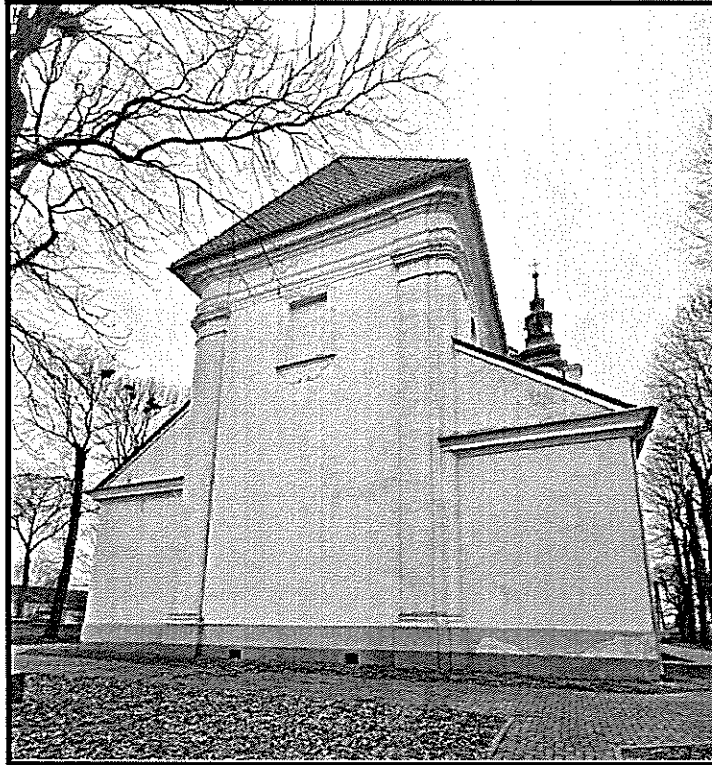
Stan zachowania detalu architektonicznego (bazy pilastra elewacji północnej).
